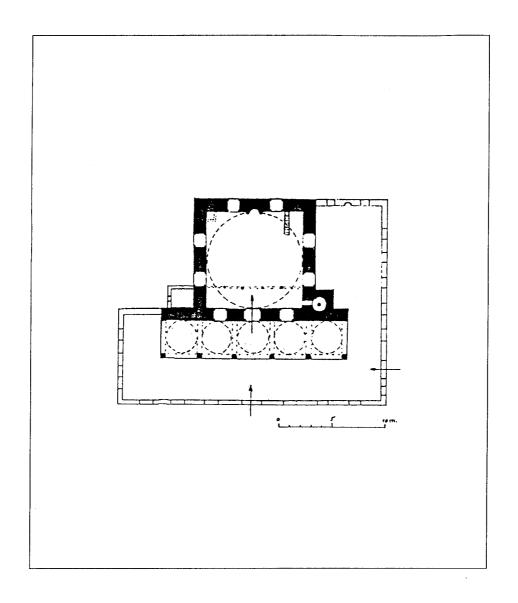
مسقط أفقي لمسجد حمزة بك في سالونيك (سلانيك) (عن : كيل) .
